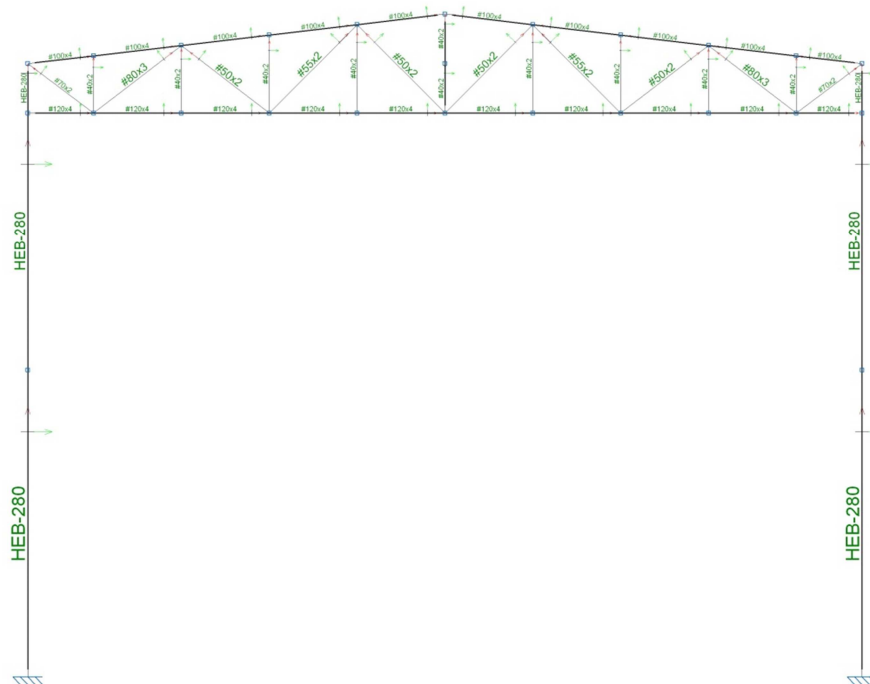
Pórtico de celosía intermedio con tirantes en fachada y cubierta
